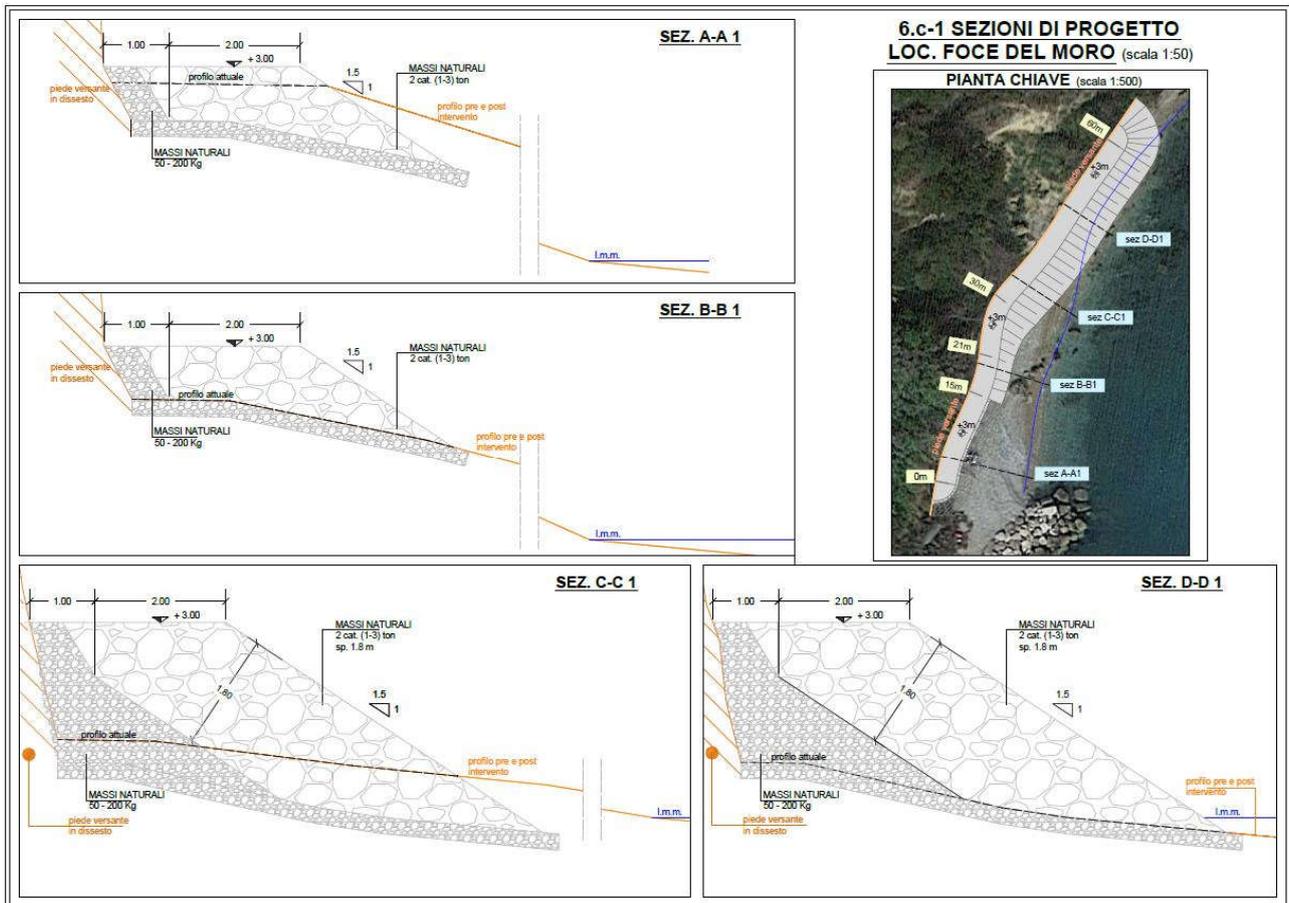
Planimetria e sezioni dell'opera in località Foce del Moro.
